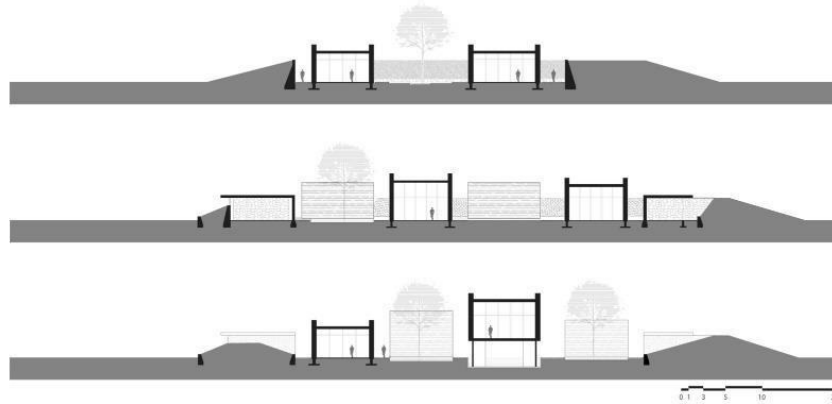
Planta Arquitectónica. Archdaily 2008.
